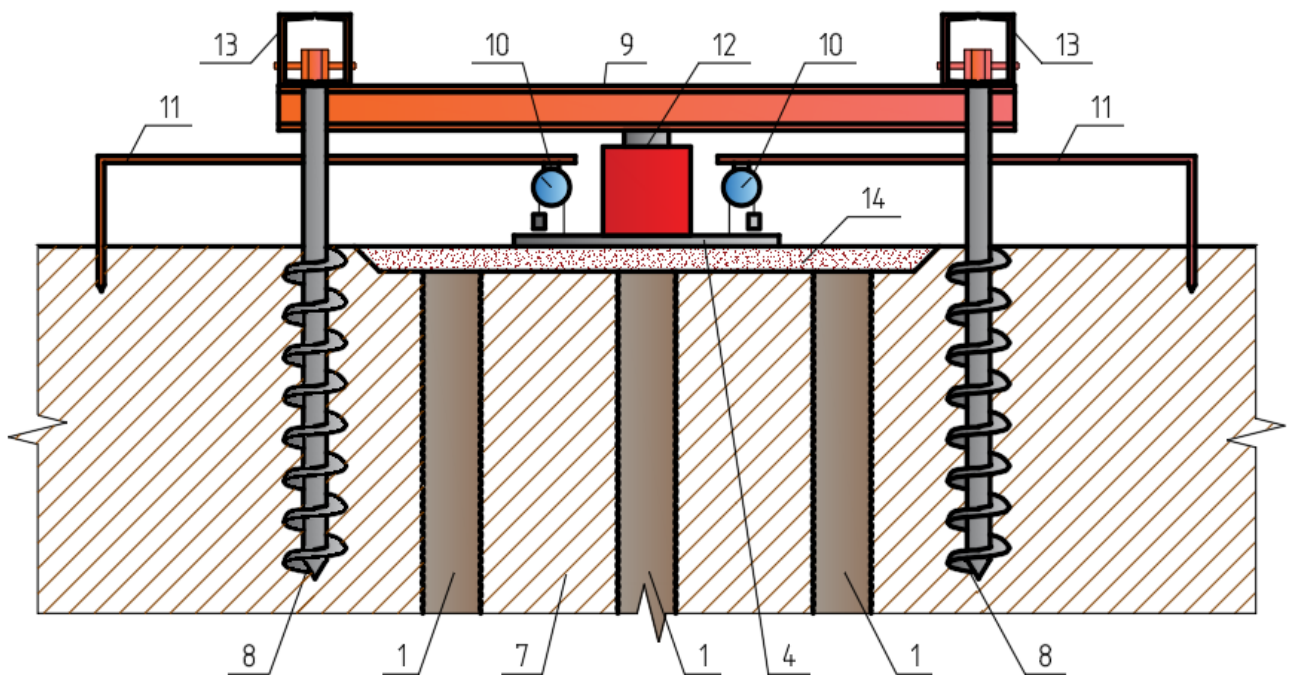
Общая схема установки, при выполнении испытания плоским штампом: 1 – вертикальные армирующие элементы; 4 – штамп; 7 – грунт вокруг армирующих элементов; 8 – анкер; 9 – продольная балка; 10 – прогибомер системы Аистова; 11 – реперная система; 12 – домкрат; 13 – поперечная балка; 14 – песчано-гравийная подушка
